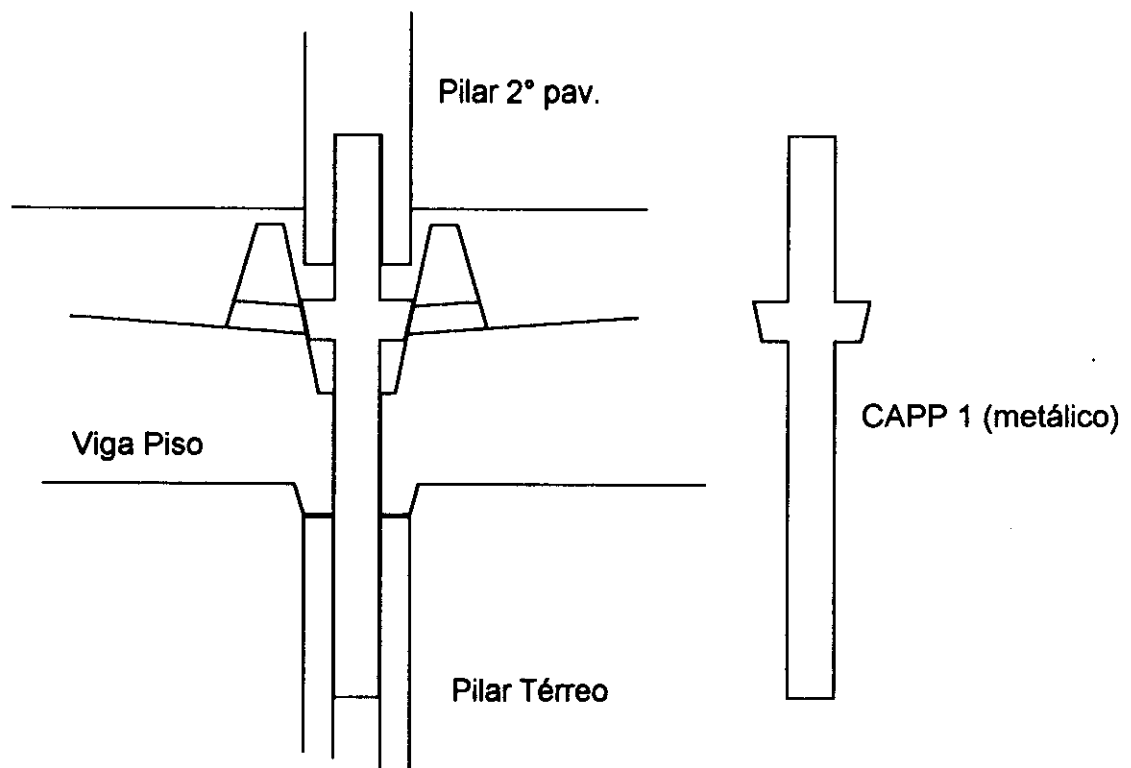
Esquema da região de ligação dos pilares superior e inferior com a viga de piso onde pode-se notar o elemento metálico de transição.
